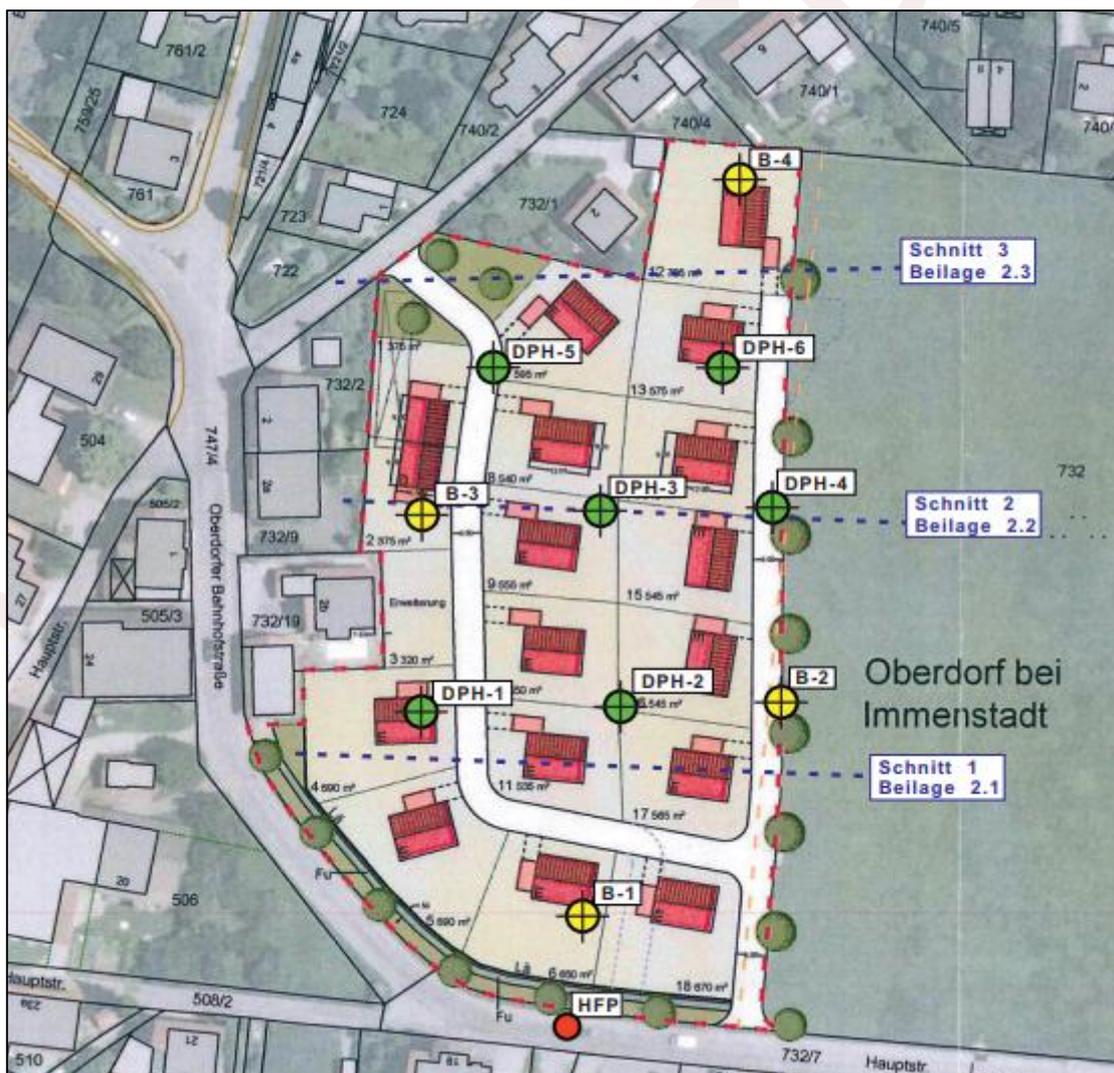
Lageplan aus dem Baugrundgutachten mit eingetragenen Untersuchungspunkten [3]
